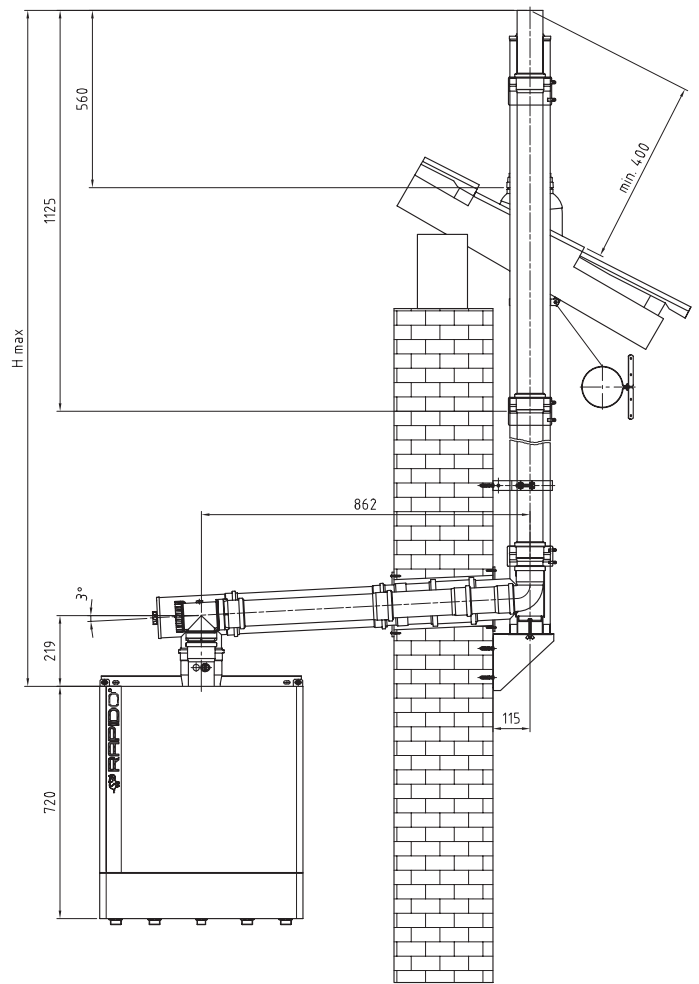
Raumluftunabhängiger vertikaler Außenwandanschluß mit Schrägdachdurchführung
